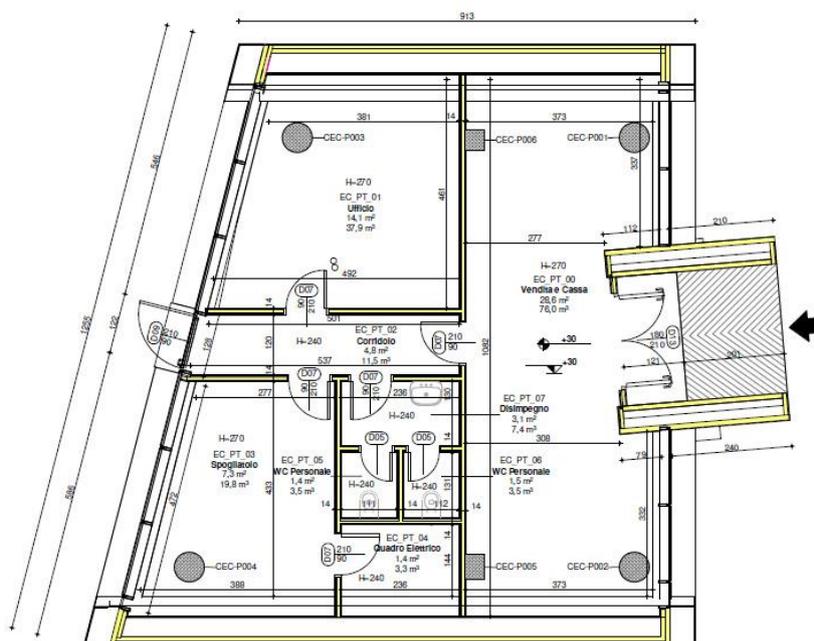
Pianta piano terra del complesso immobiliare in progetto
